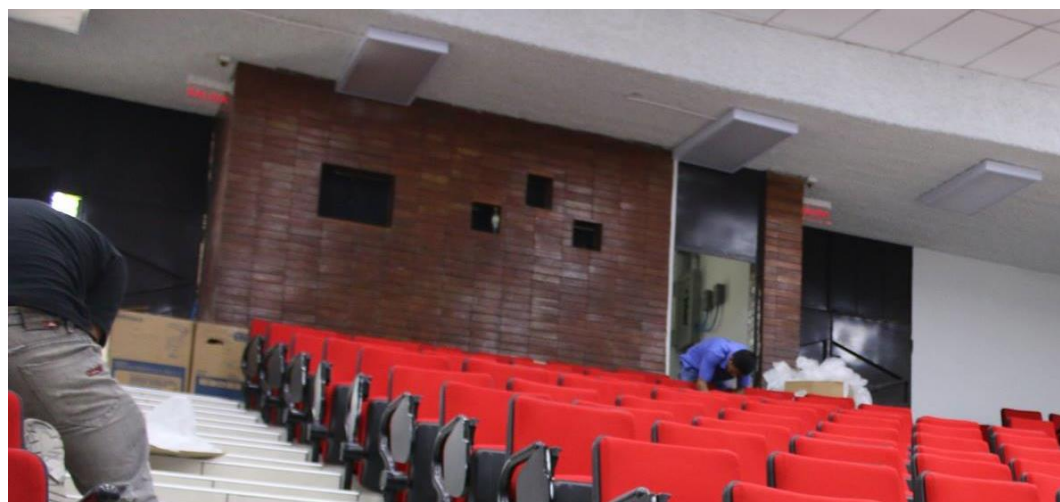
Caseta de proyección de auditorio Mármol en la Facultad de Ingeniería U.E.S. Central
